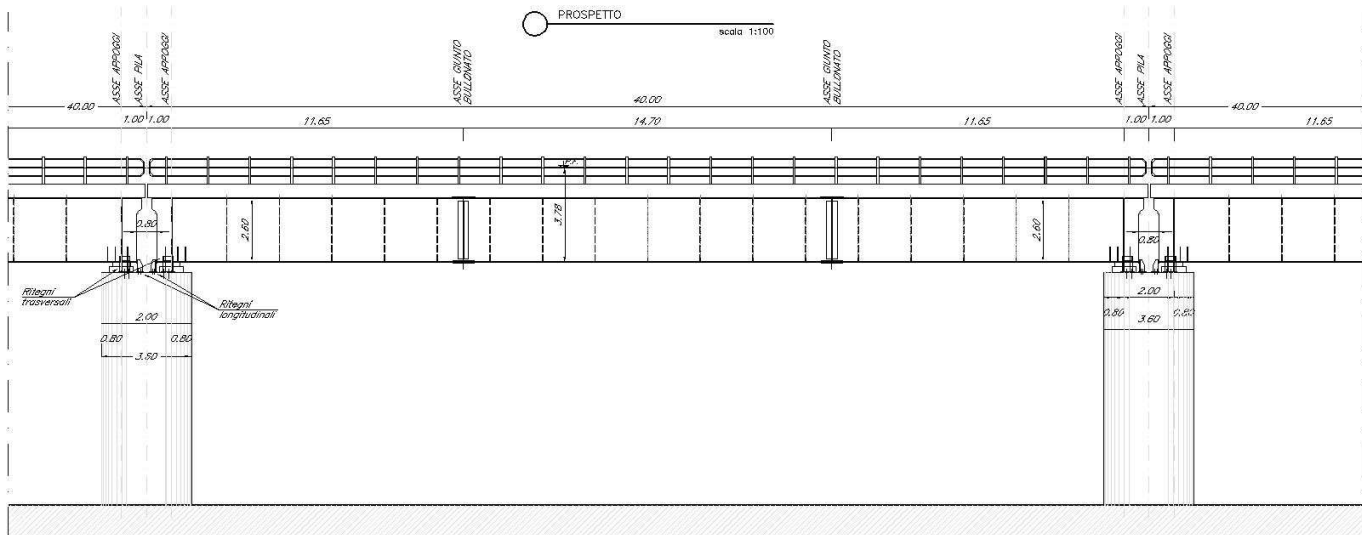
Prospetto impalcato a struttura mista acciaio/cls.
